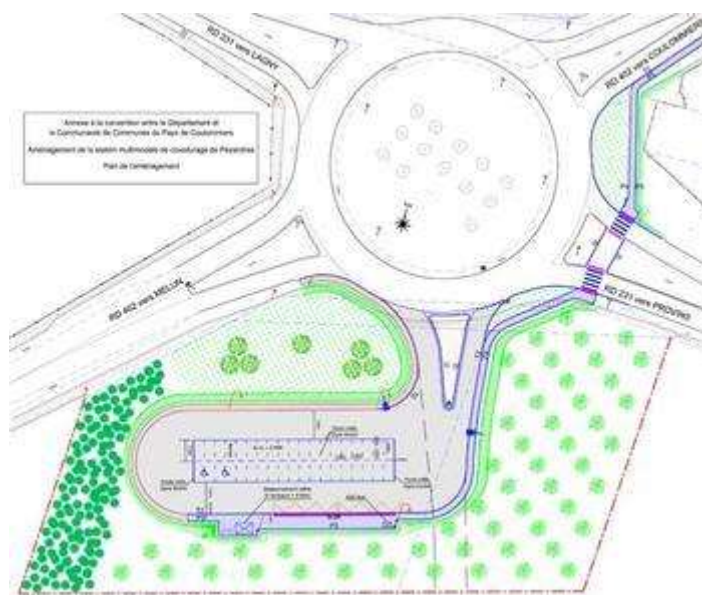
Plan de l'aire de covoiturage de Pézarches (source : Communauté d'agglomération Coulommiers Pays de Brie).
